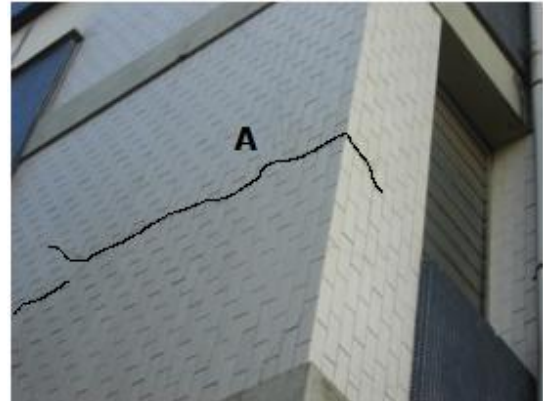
Fissuras/Fendas horizontais no avançado “A”
